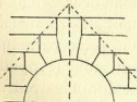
Кладка арки изъ плоскихъ тесанныхъ камней въ перевязь съ рядами фасада.
